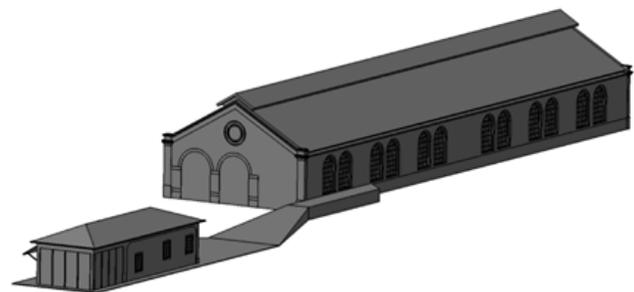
Modelagem baseada apenas nas plantas: Estação ferroviária da Vila ainda está em fase de construção física. A partir das plantas do projeto, reconstrói-se o modelo 3D.
